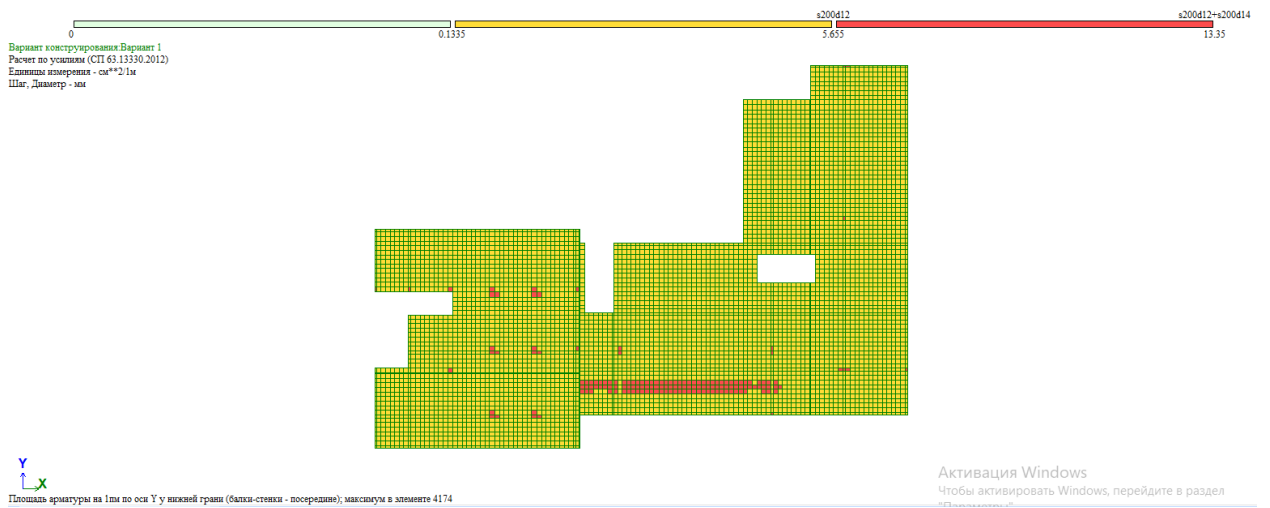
Подбор нижней продольной арматуры плиты по оси Y
